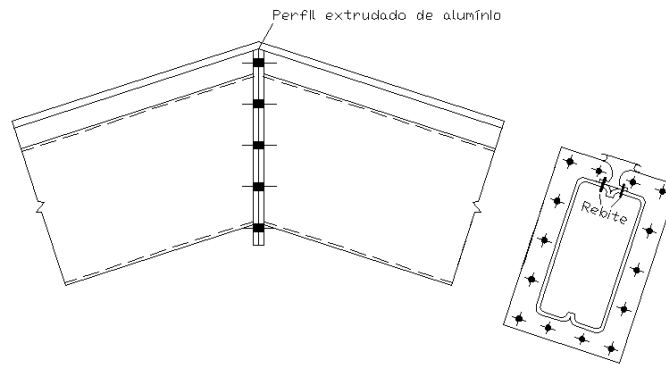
Esquema da ligação na cumeeira entre as duas vigas
